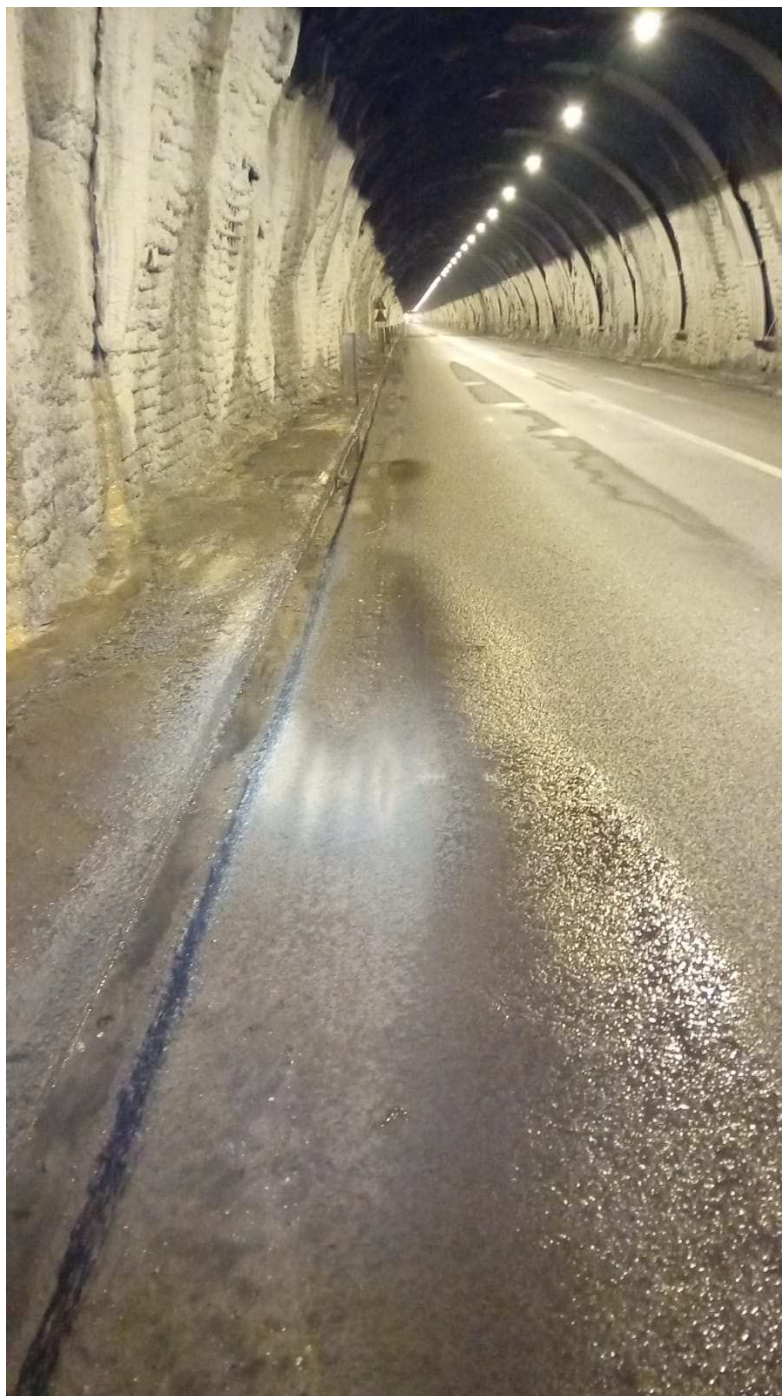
nuovi apporti di acqua in carreggiata dalla volta della galleria Ponte Pià
